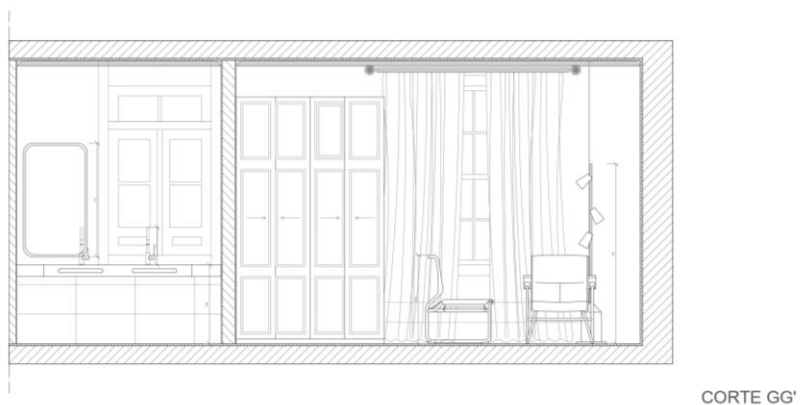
Pormenorização. Corte GG'. Fonte: Ana Ferreira
